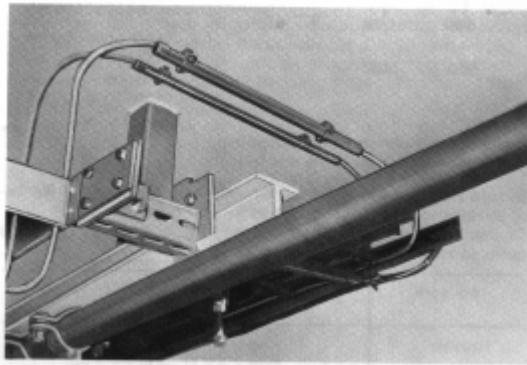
Protezione meccanica del cavo di bus tramite montaggio protetto
